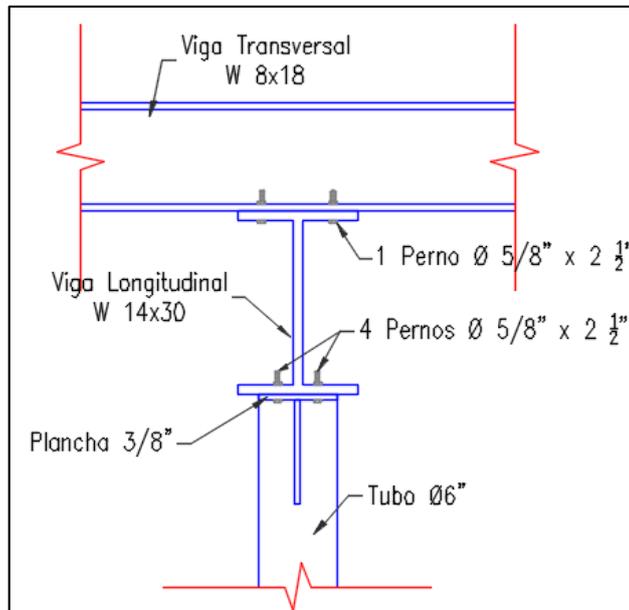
Detalle de poste – viga longitudinal – viga transversal.
